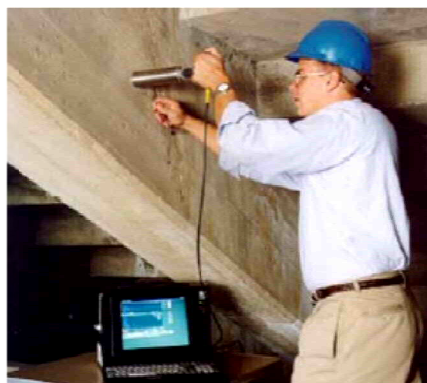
Equipamento de ensaio da técnica de eco ultrassônica
